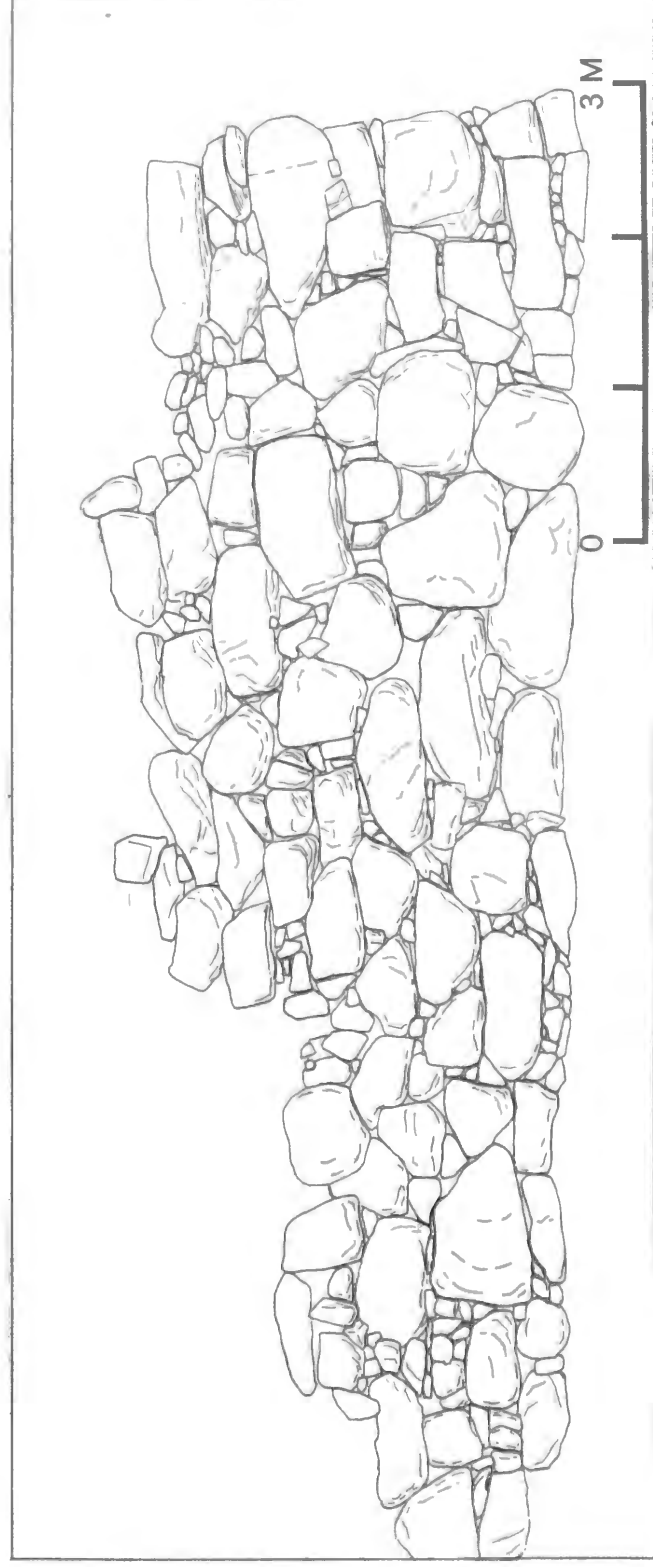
观音寺城伝「本丸」虎口跡石垣立面图
